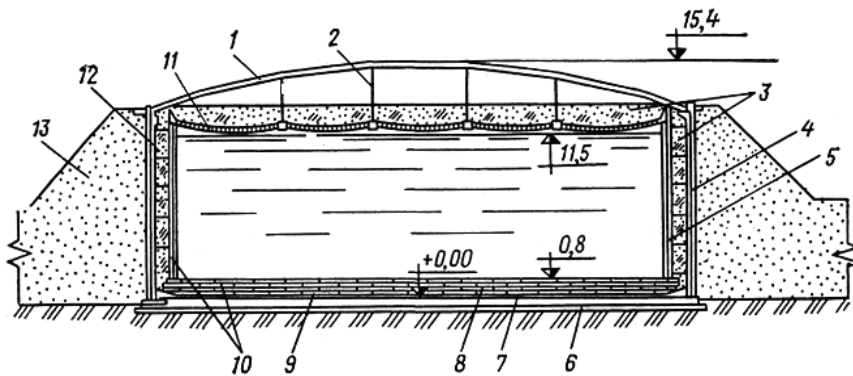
Залізобетонний резервуар для пропану об'ємом 1000 м^3 : 1 – збірний залізобетонний купол; 2 – підвіска; 3 – шар спученого перліту товщиною 1000 мм; 4 – зовнішня залізобетонна стінка; 5 – підпірна стінка з торкретбетону; 6 – труба підігрівача; 7 – гідроізоляція; 8 – днище з попередньо напруженого залізобетону; 9 – шар піноскла; 10 – внутрішні стінки; 11 – додаткове навантаження з керамзитобетону; 12 – сталева розтяжка; 13 – піщаний ґрунт
